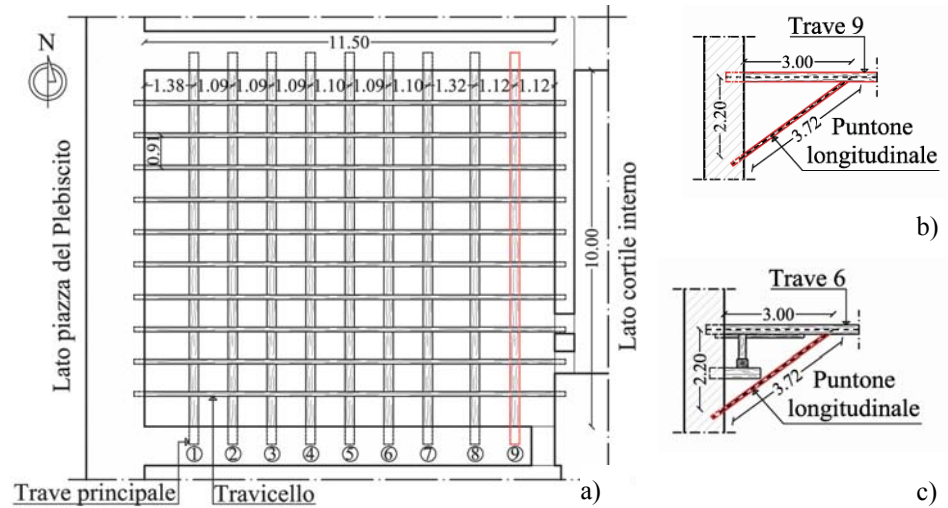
Consolidamento solaio: a) Carpenteria con 9 travi; b) Irrigidimento trave 9.
